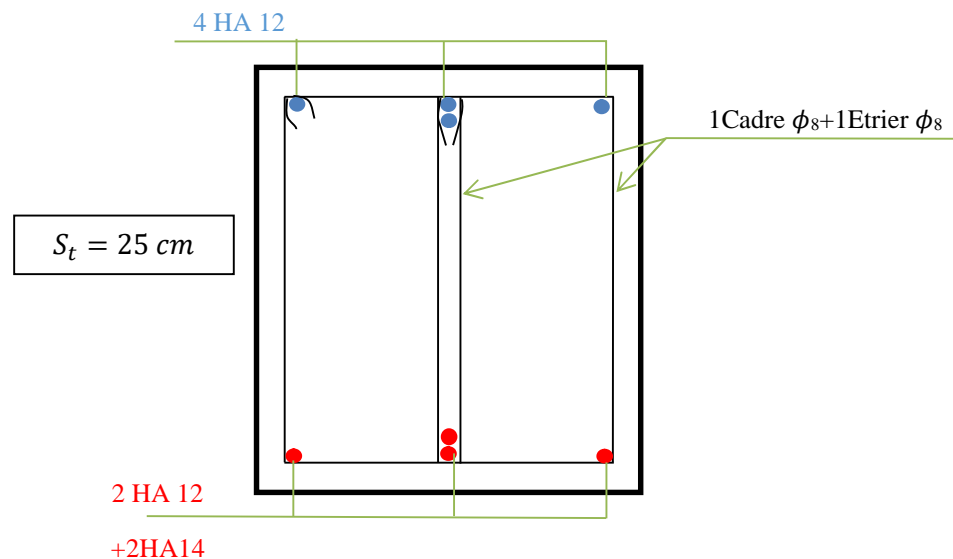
Schéma de ferrailage de la poutre de chaînage
